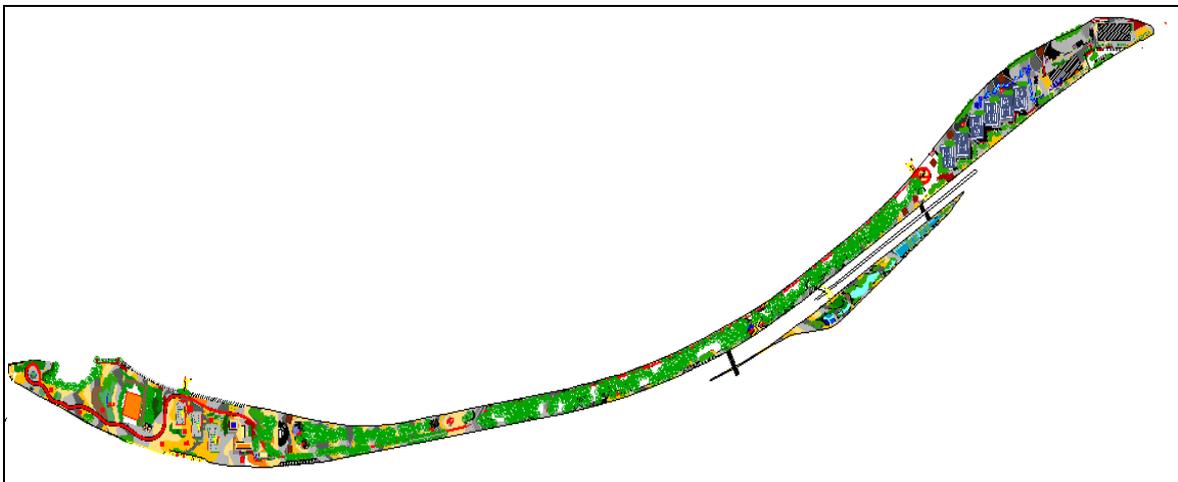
Planta baixa proposta para o Calçadão da Suframa.
